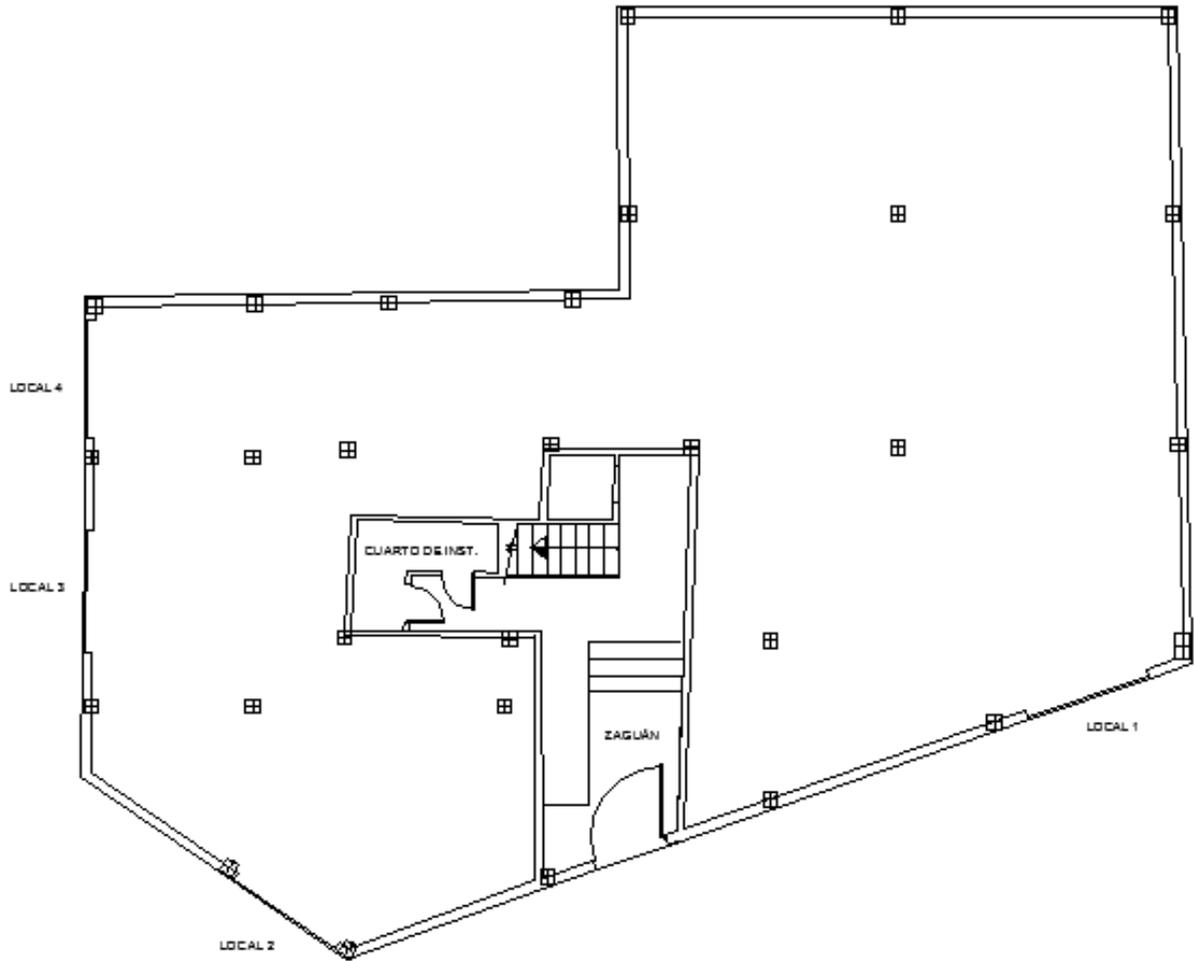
Situación PLANTA BAJA edificio avd. Francia nº39 Vila-real (Propia).
